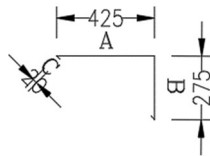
42: Tulangan Melintang Plat Tangga Potongan A-A Tangga Tipe 1
